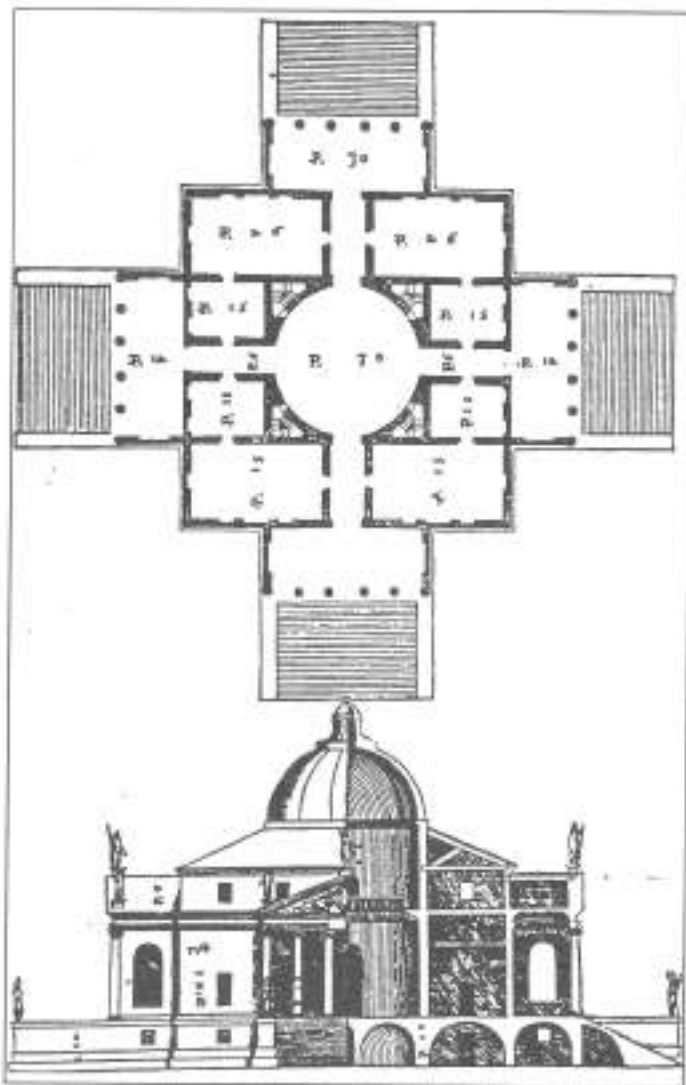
A. Palladio, *La Rotonda*, Vicenza. Pianta, sezione-prospetto.
